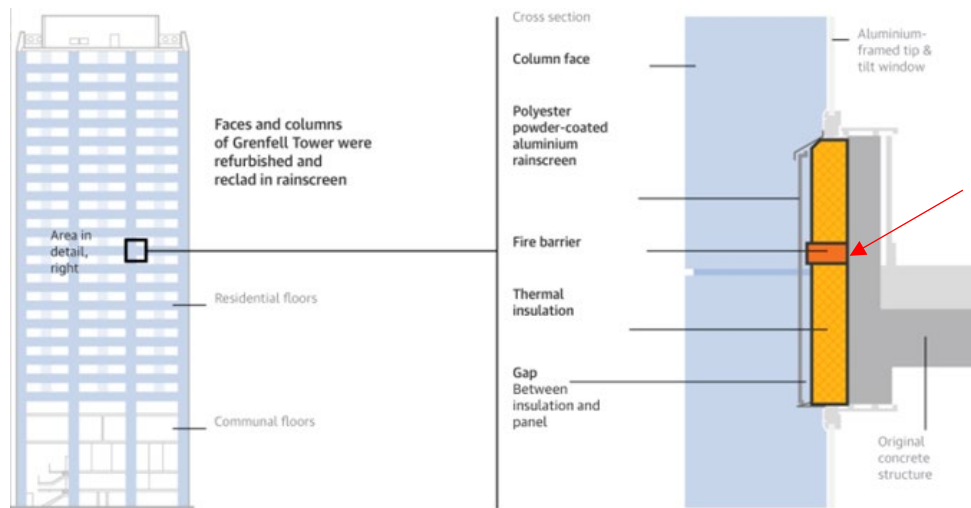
Detalle constructivo de la fachada del edificio Grenfell. Diversos factores relacionados con el sistema de fachada fueron el detonante para la rápida e intensa propagación del fuego. Fachada ventilada mal compartimentada, paneles de revestimiento combustible, aislante térmico combustible
